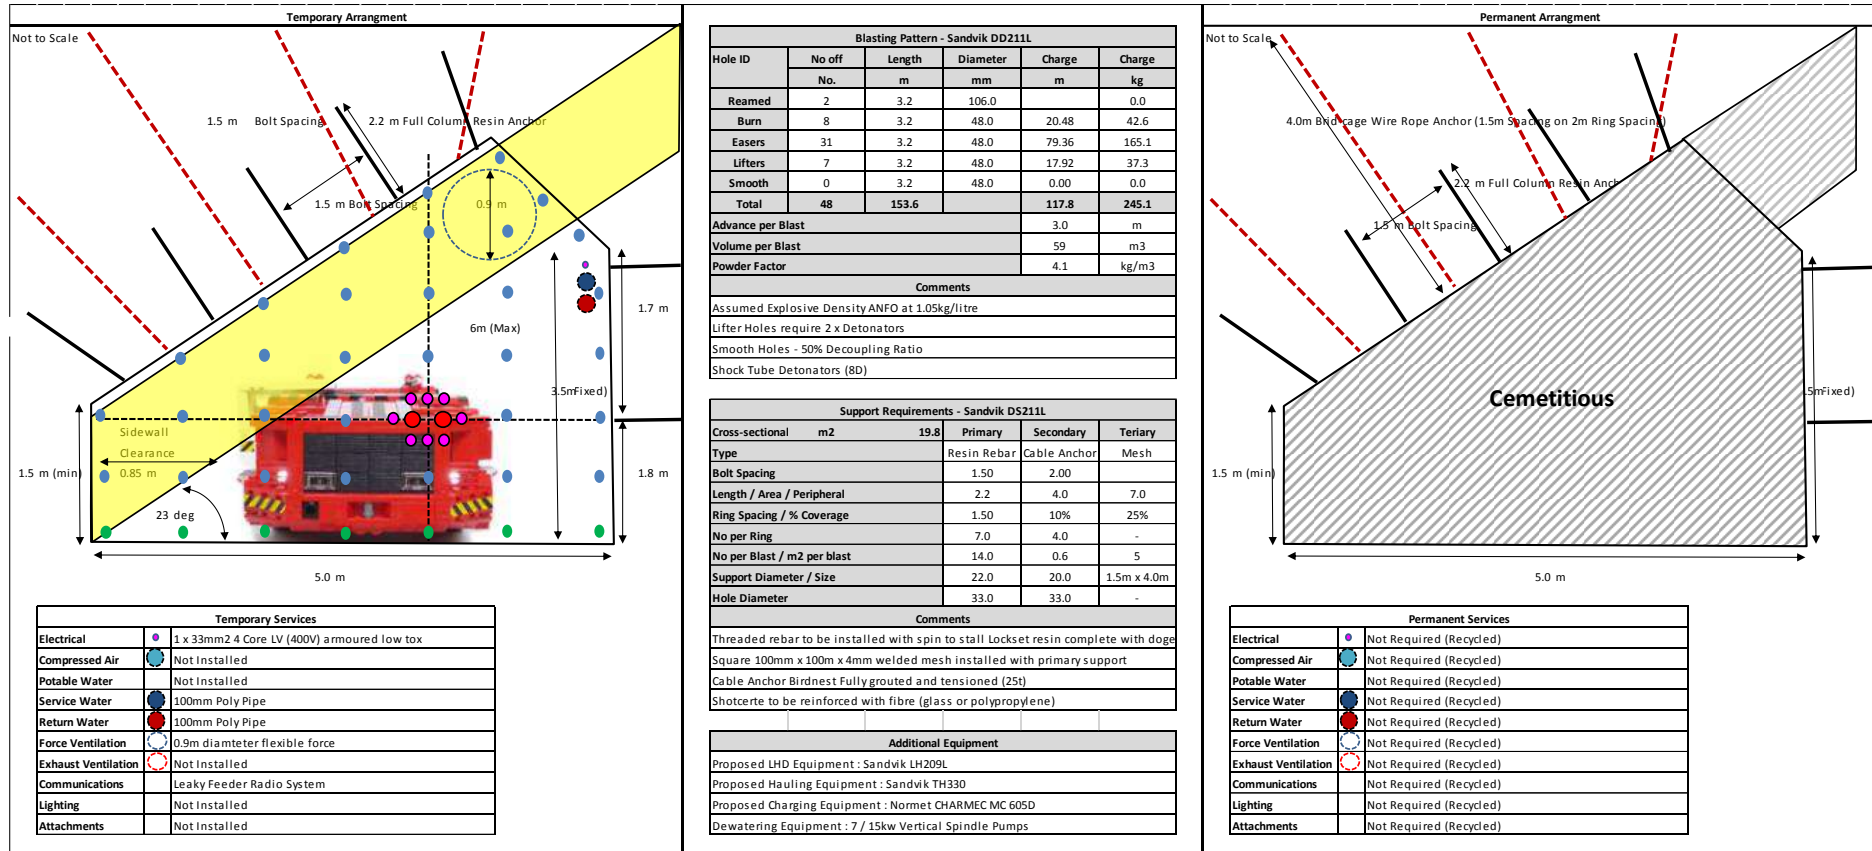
Configurazione dell'estremità di sviluppo dei tunnel di coltivazione in LHRF Longitudinal LHRF
